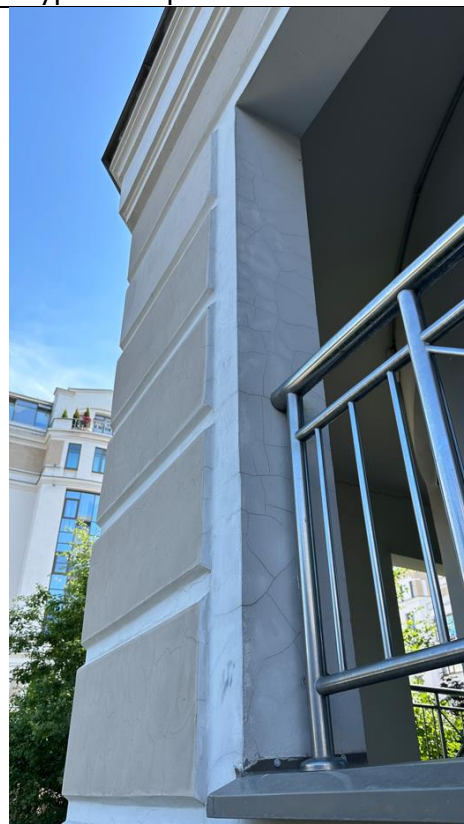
Виды дефектов фасада в виде трещин по краске, штукатурке и облицовке
